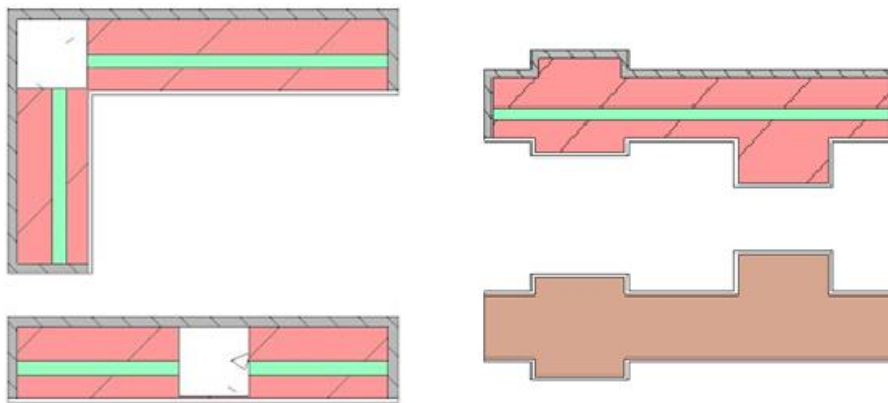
Diferencia en unión de muro entre pilar arquitectónico y estructural [4]
